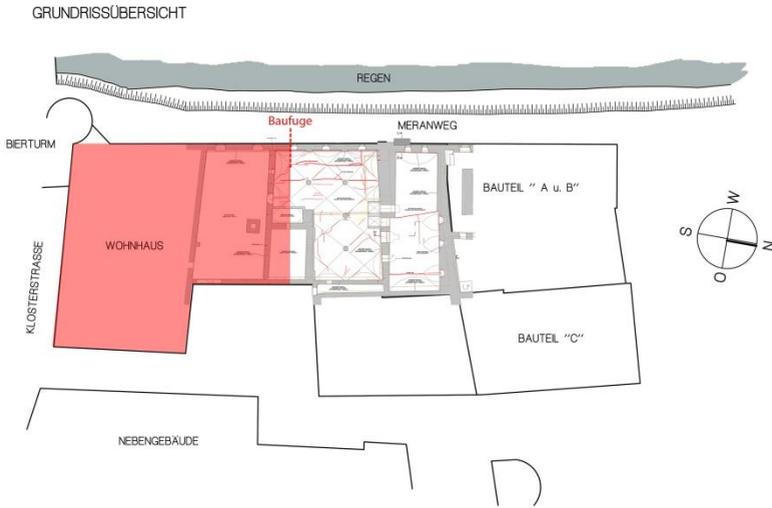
Lageplan des Höchstetterareals mit dem vermuteten Grundriss des ersten Baus des „Chamer Stadtschlusses“
